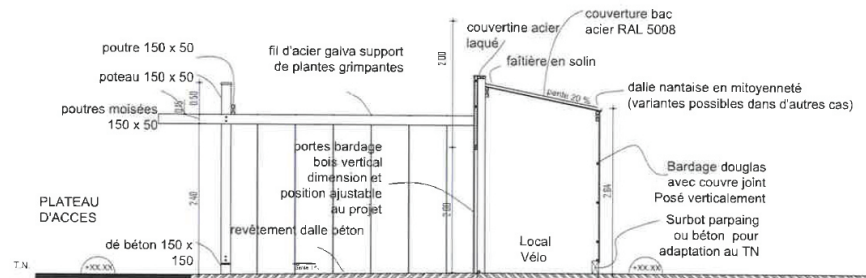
Exemple constructif (document non contractuel) dans le cas d'une construction d'une pergola + cabanon bois
